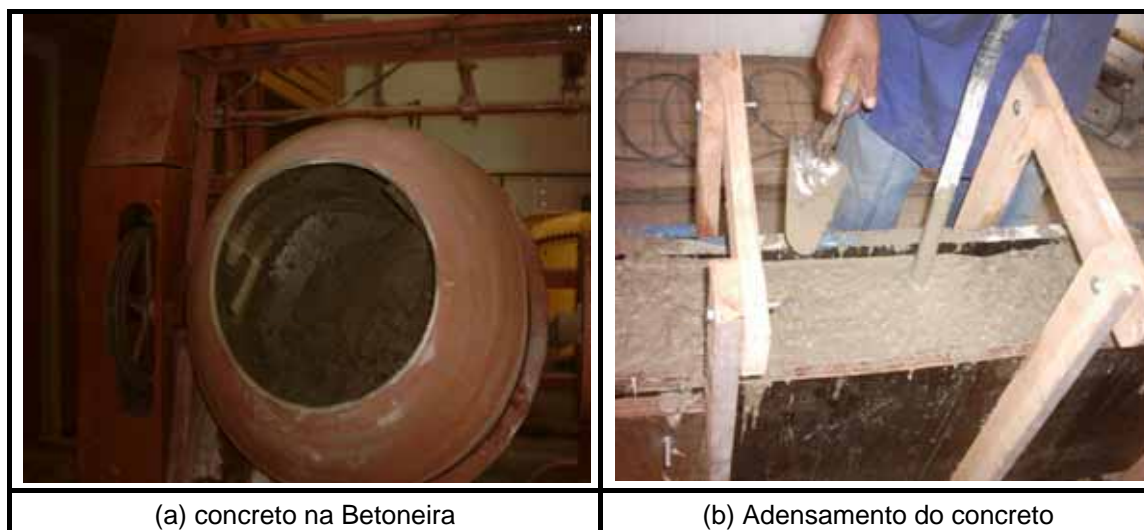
Concreto sendo misturado na betoneira (a) e adensamento do concreto lançado na forma, com vibrador (b).
